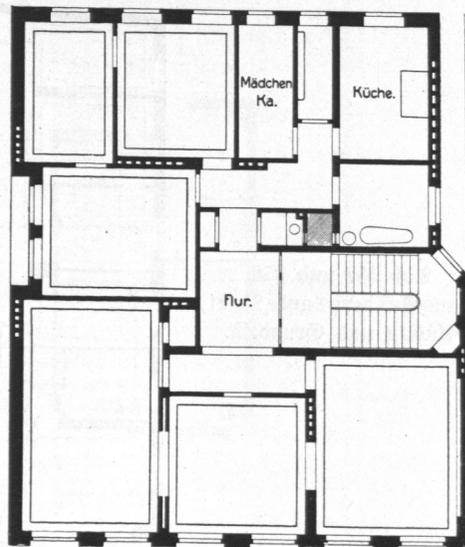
Haus Steinhauerdamm 2. Grundriß.
